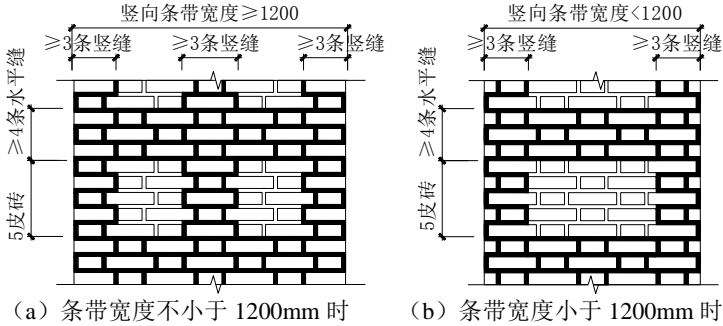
高延性混凝土竖向条带嵌缝示意图
